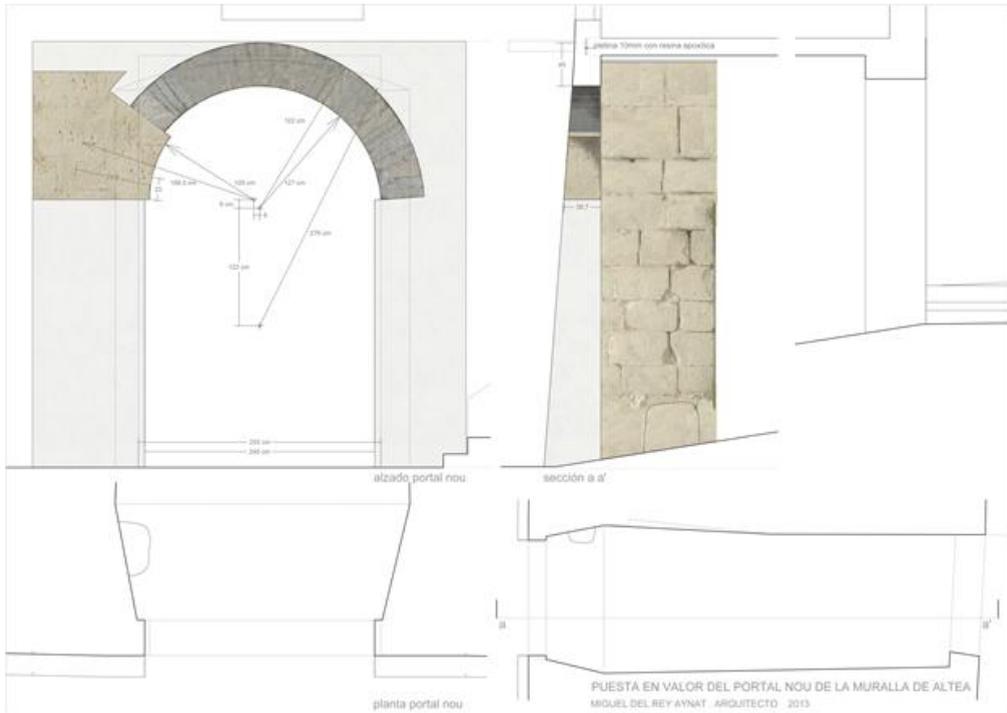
Plano de restauración del Portal Nou (M del Rey, 2013)
